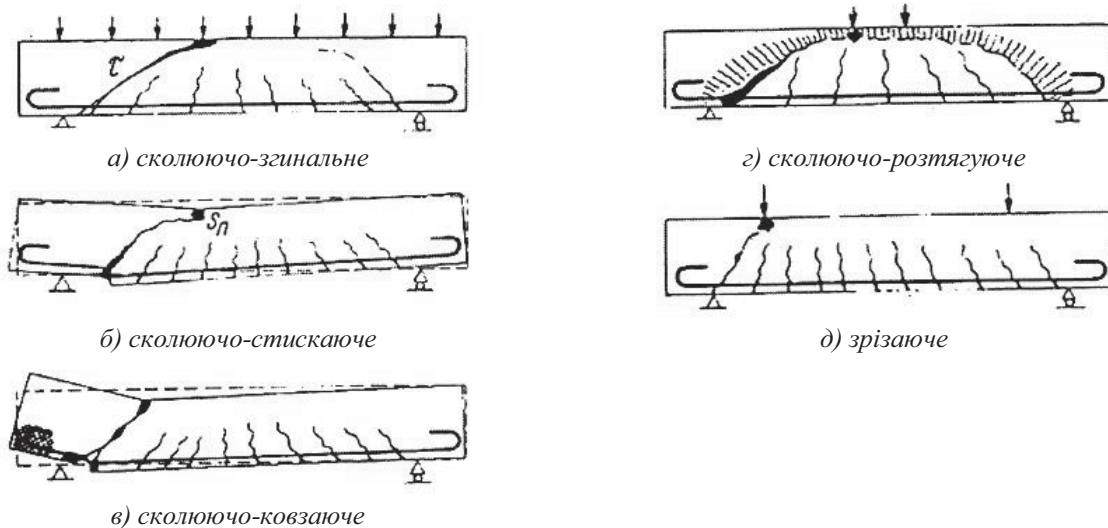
Схеми руйнування залізобетонних балок за [6]
